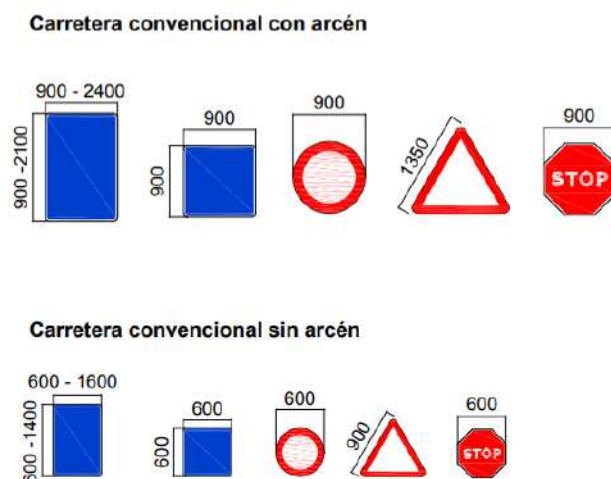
(Cotes en mm) Dimensions senyalització vertical. Instrucció de carreteres 8.1-IC
